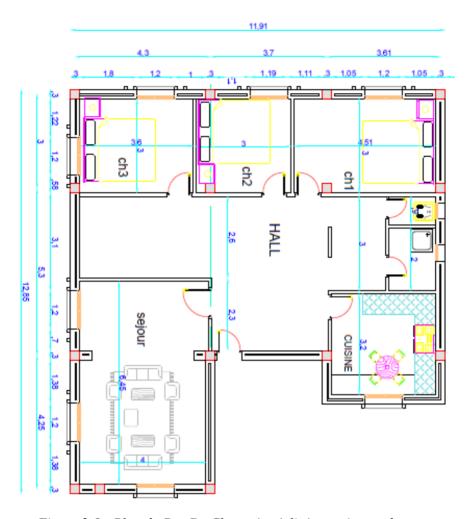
Plan du Rez-De Chaussée réalisé avec Autocad.
